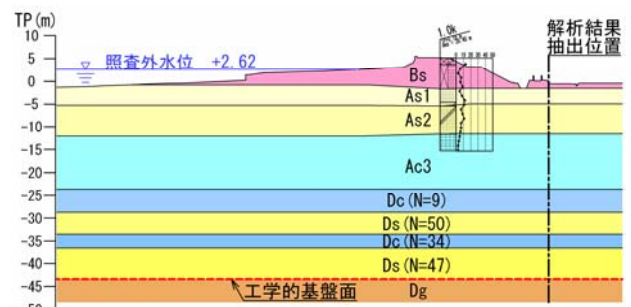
矢作川下流部(R1.0)の基礎地盤断面図
